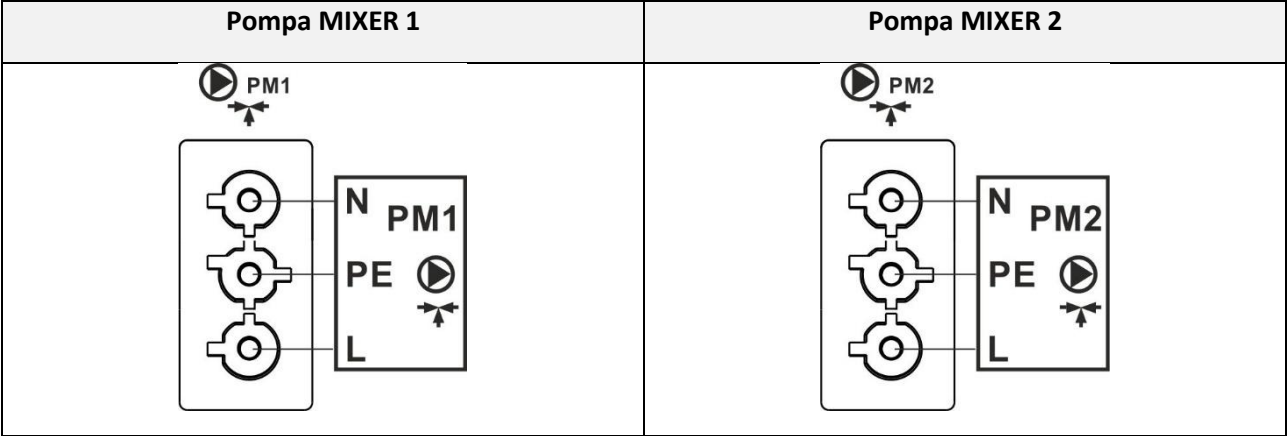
Schema elettrico del collegamento delle pompe MIXER
